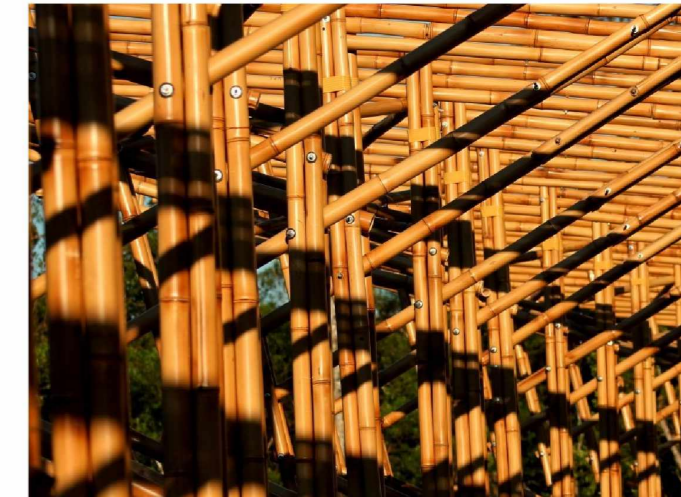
Estrutura de bambu previamente montada. Fonte: ArchDaily
